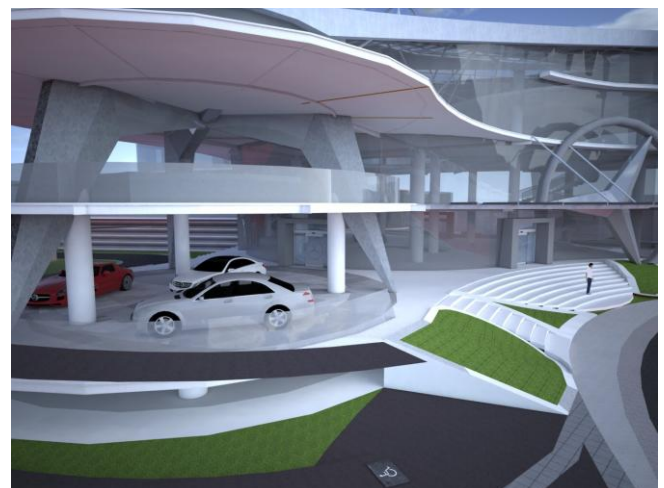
Sistem Pelingkup Bangunan - Tampak
